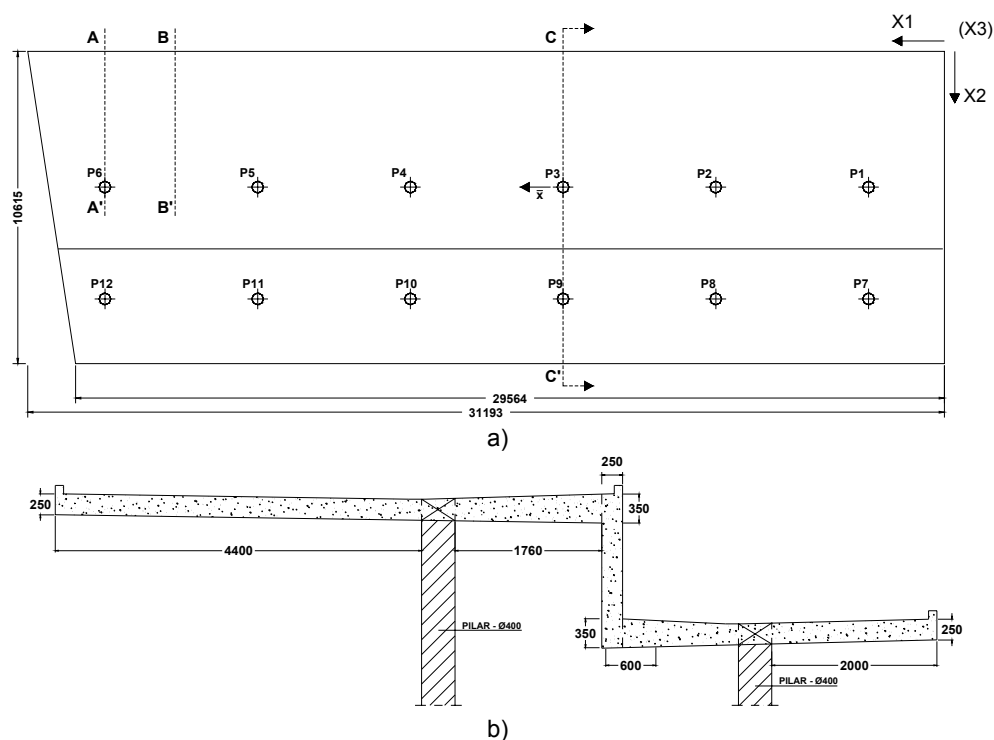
Estrutura de betão armado em análise: a) Vista em planta da estrutura; b) Vista em corte da estrutura no alinhamento C-C' (unidades em mm; Pi= pilar i)
